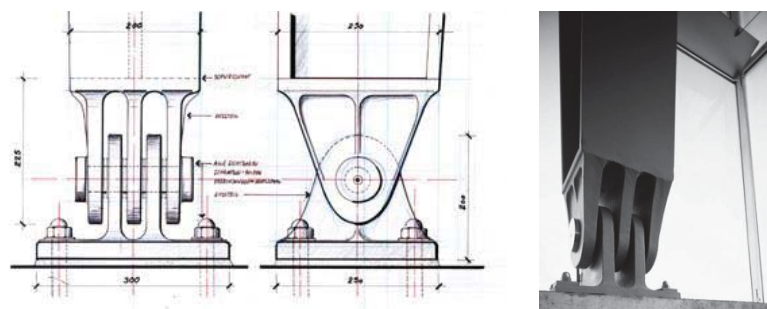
Detalhe dos Aparelhos de Apoio (Fonte: Sánchez, 2007).
